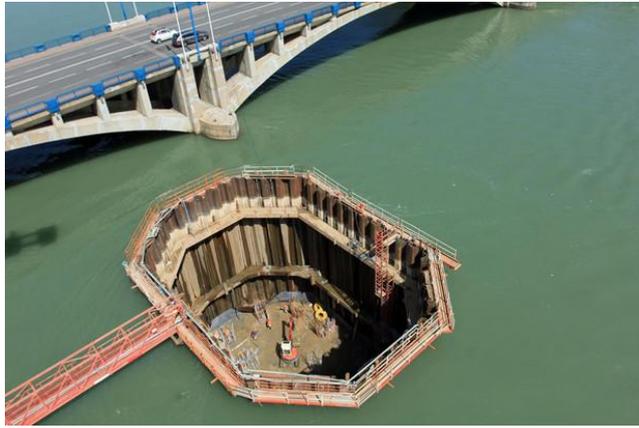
Construction du pont Raymond Barre à Lyon dédié au tramway, à gauche vue de la pile 1 et du batardeau en avril 2013, image SYTRAL [6]
